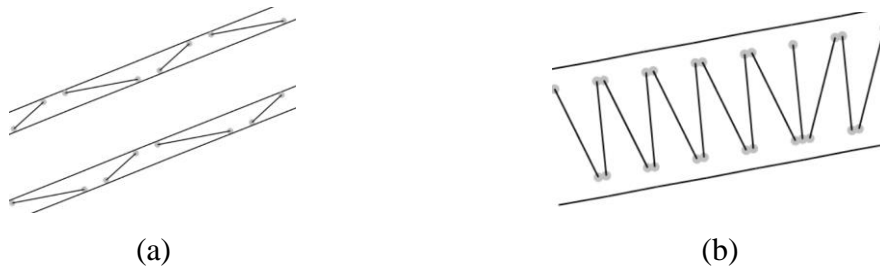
Exemplos de Barras interiores dos Painéis: (a) Barras bi-articuladas Painéis Horizontais Tipo; (b) Barras bi-articuladas Painel Vertical Tipo
